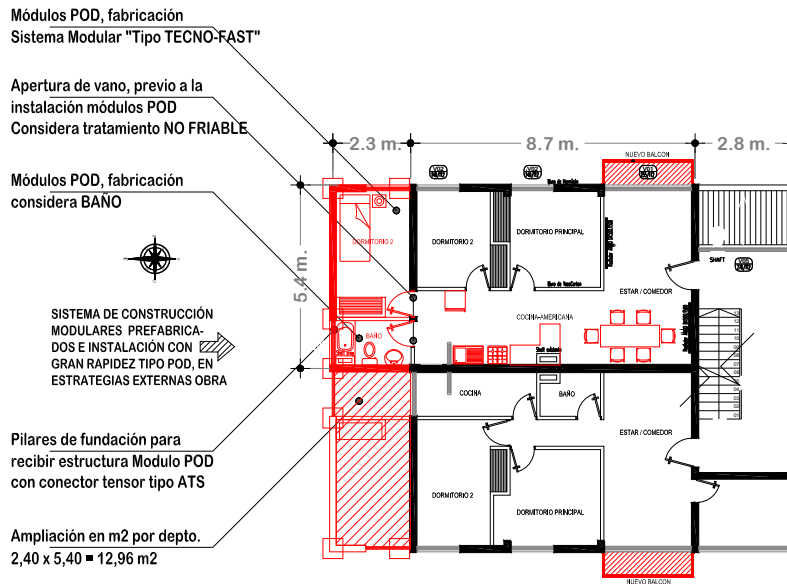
Nueva Planta Distribución, Depto. de Block 1010, Fuente: Elaboración propia. Software: AutoCAD
